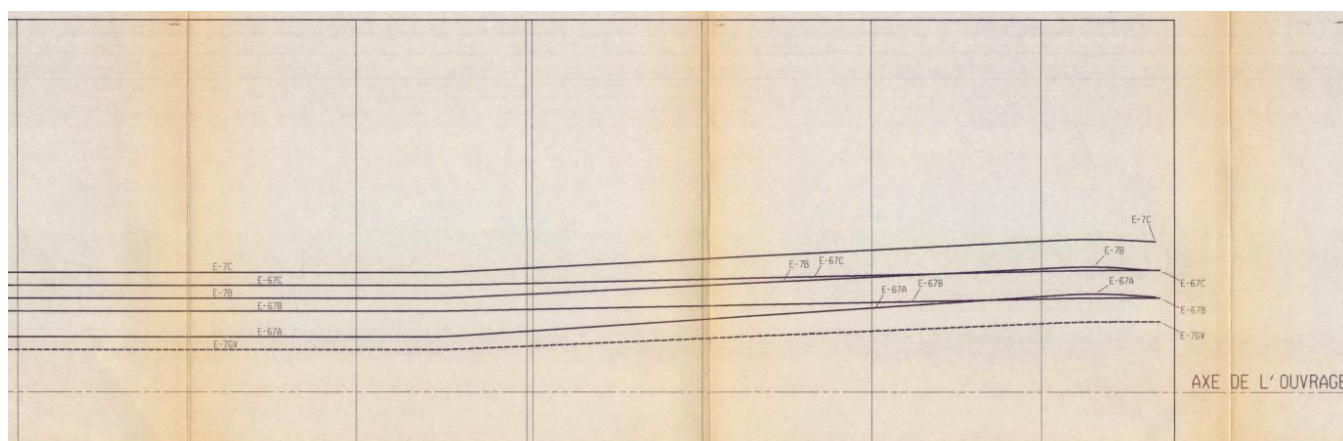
Extrait de la vue en plan des câbles extérieurs sur la travée 7 - P457
